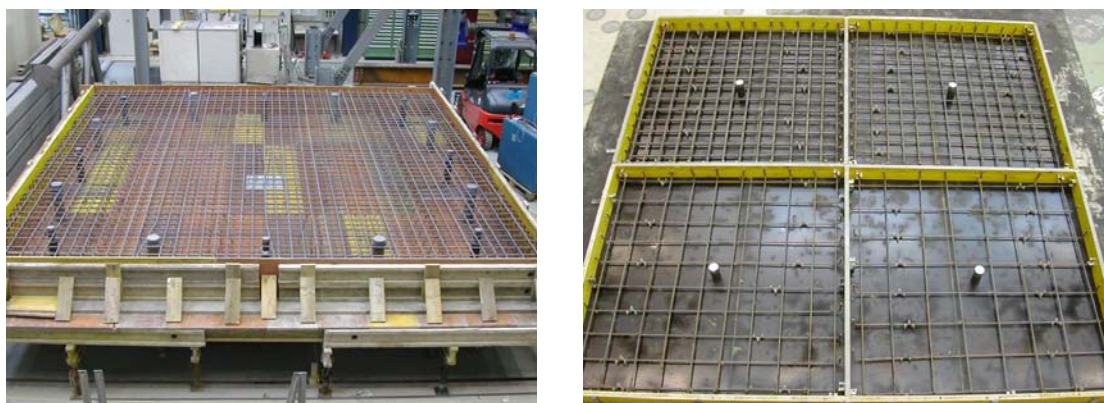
Armature de la grande dalle PG-3 et des petites dalles PG-6 à PG-9
